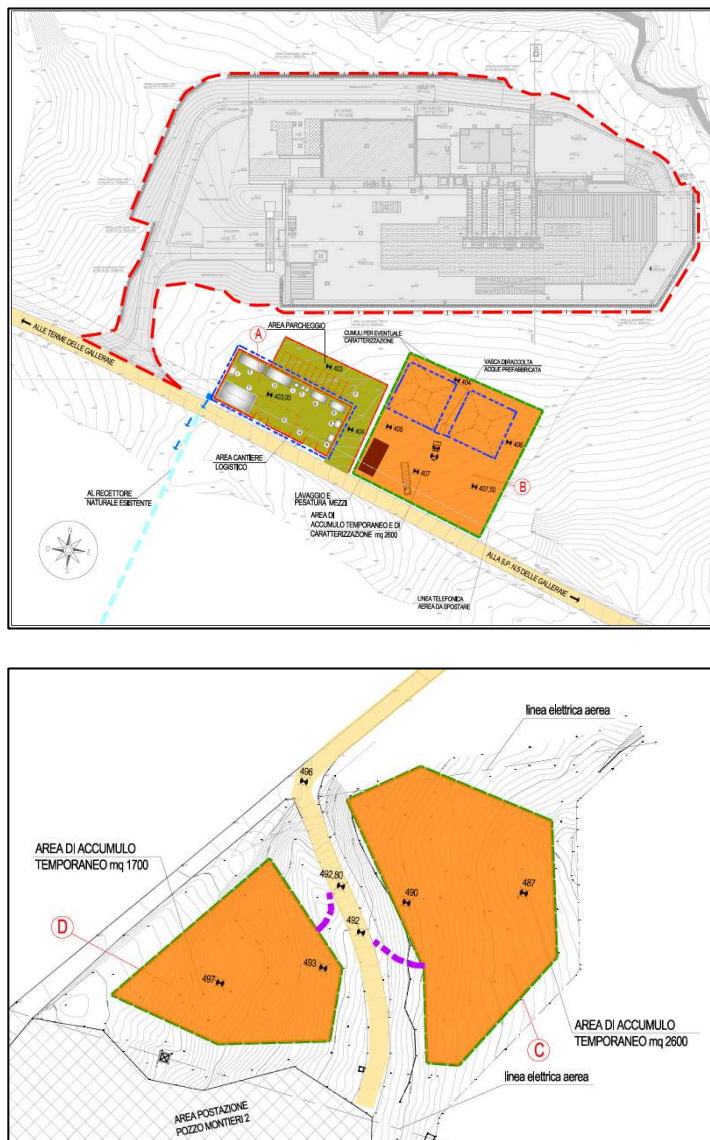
Disposizione delle aree di cantiere ed identificazione delle aree di accumulo temporaneo e di caratterizzazione (Area B) e di accumulo temporaneo in attesa di conferimento (Area C+D) - Stralcio elaborato di progetto R35045_Pcant. Planimetria e pianta cantiere civile.
